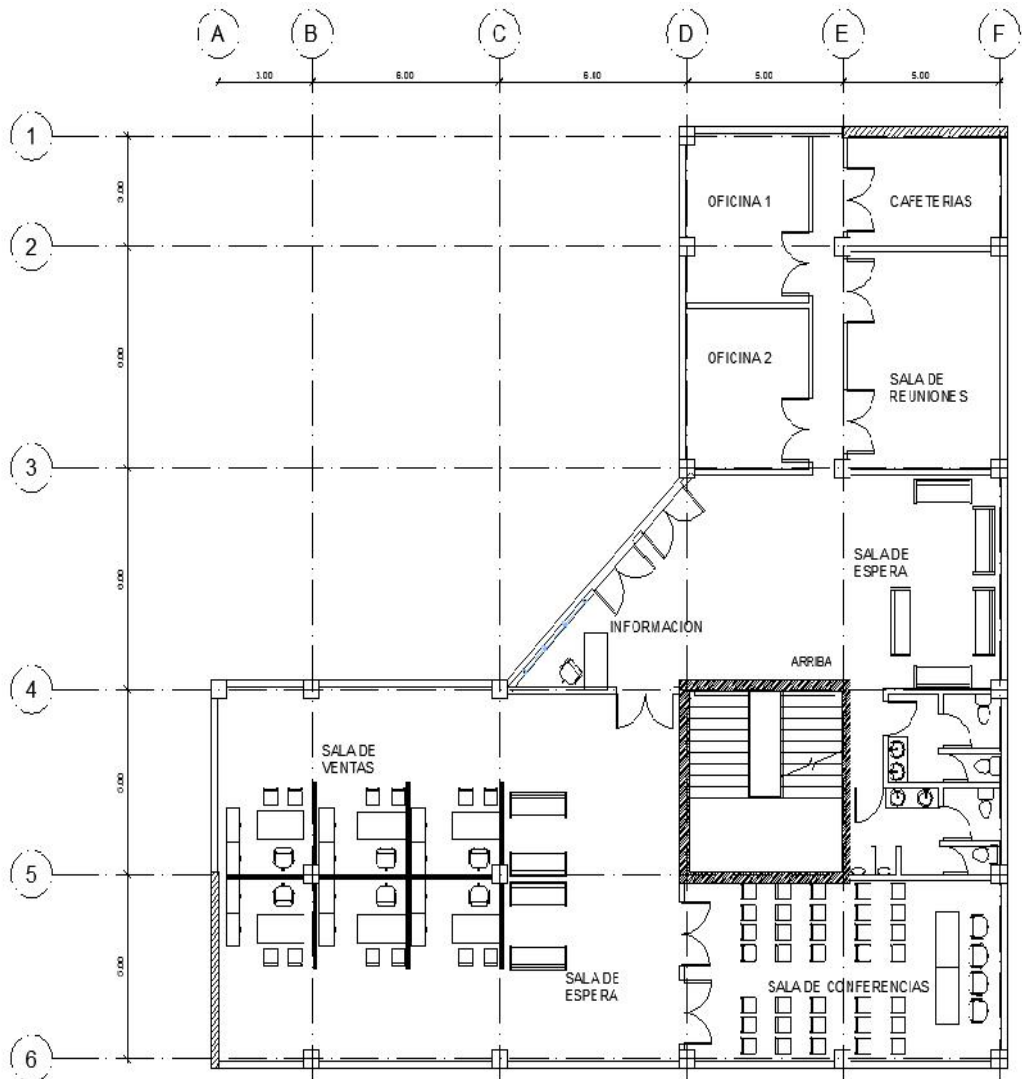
Planta tipo 1 Oficinas, Distribución arquitectónica
